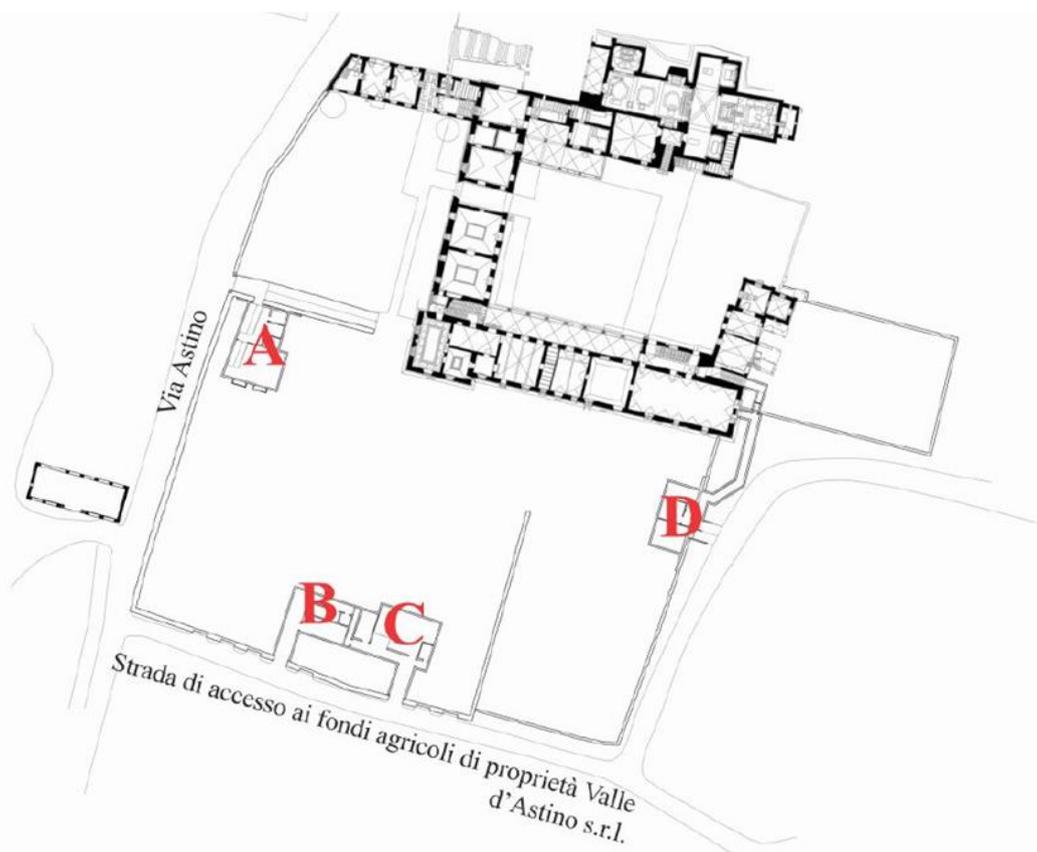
Planimetria di progetto con individuazione dei relativi blocchi dei fabbricati (Studio Architetto Domenico Egizi), allegata nella documentazione di progetto depositata in Comune di Bergamo
